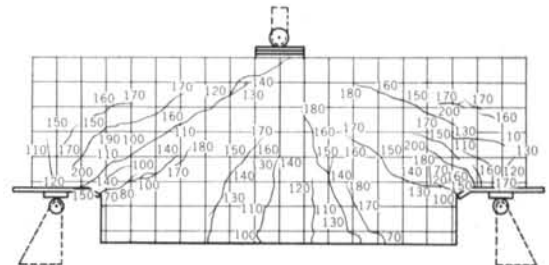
試験体A<sub>2</sub>表面のひび割れ図
